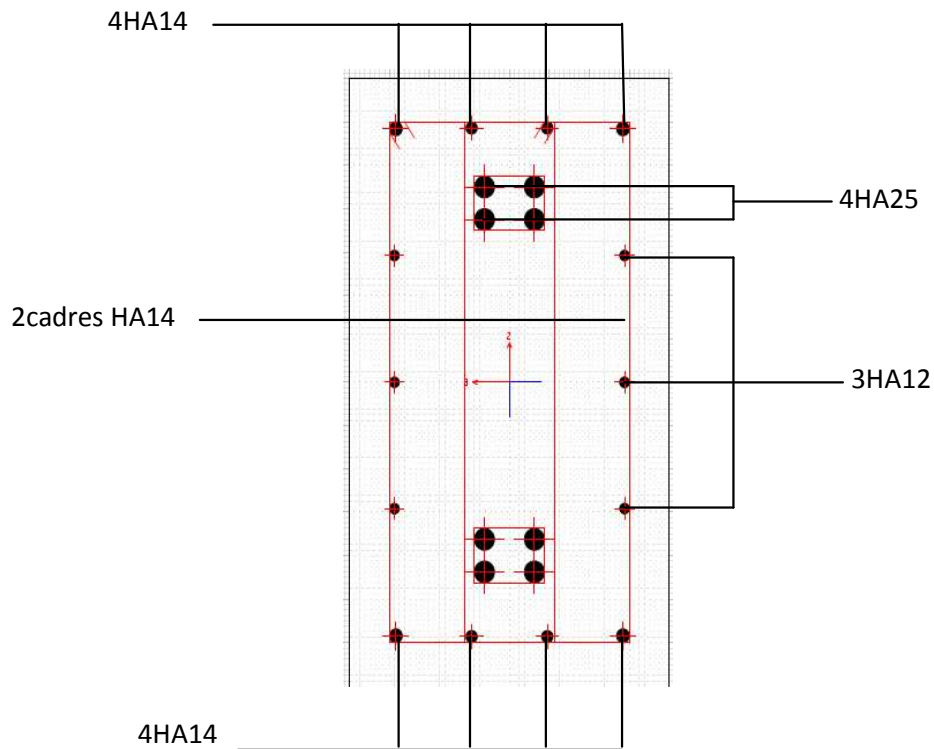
schéma du ferrailage d'un trumeau- armatures longitudinales, transversales, de peau et diagonales.
